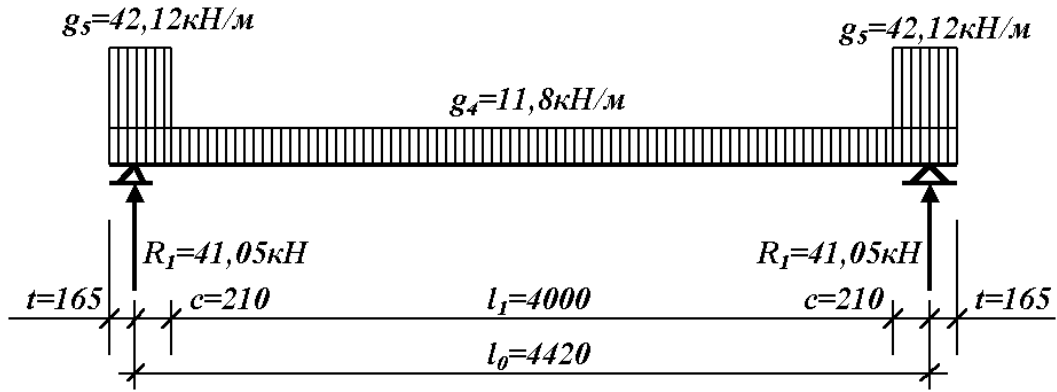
Розрахункова схема фундаментної балки для першого випадку завантаження
